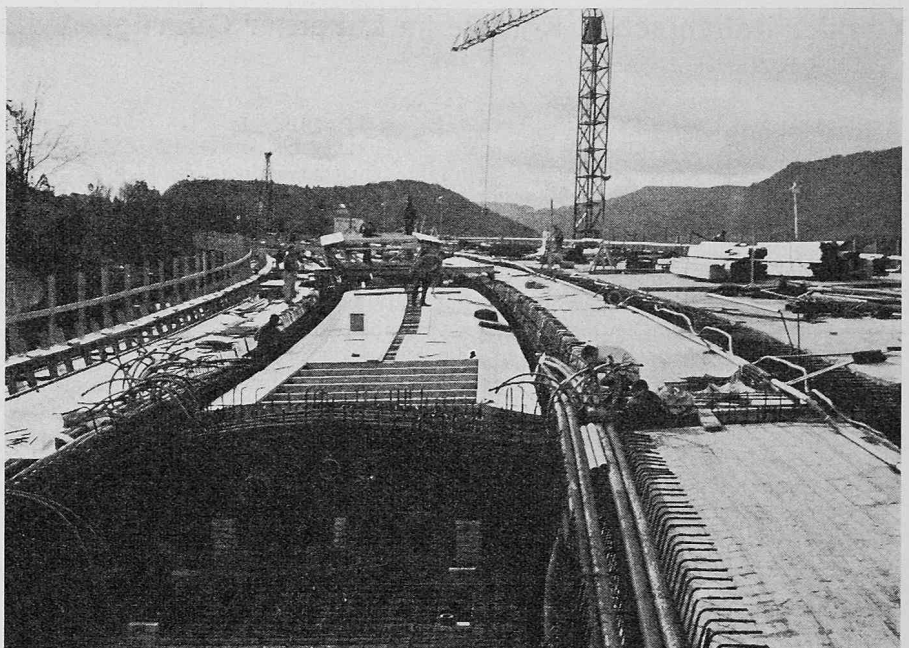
Ueberbau Etappe 1a. Einbau der Schalungselemente für die innere Kastenschalung im linken Kasten. Rechte Brückenhälfte bereits betoniert
